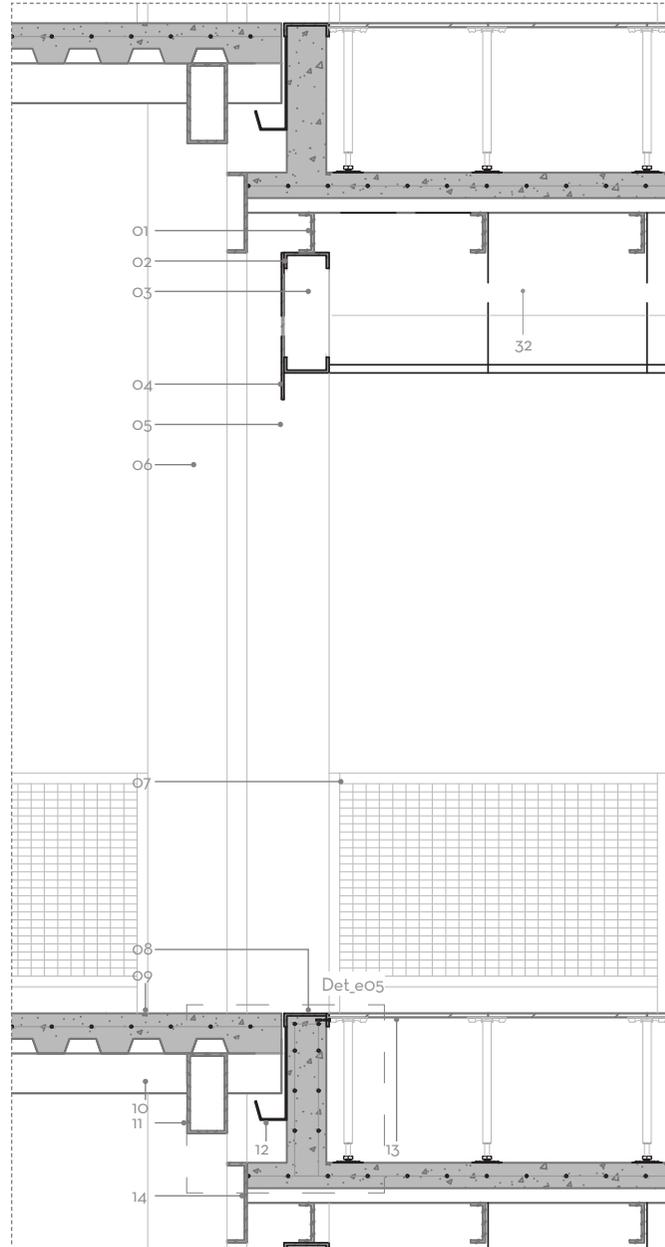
Det_G_05 Escantillón junta losa de vestibulo exterior y losa de piso técnico
